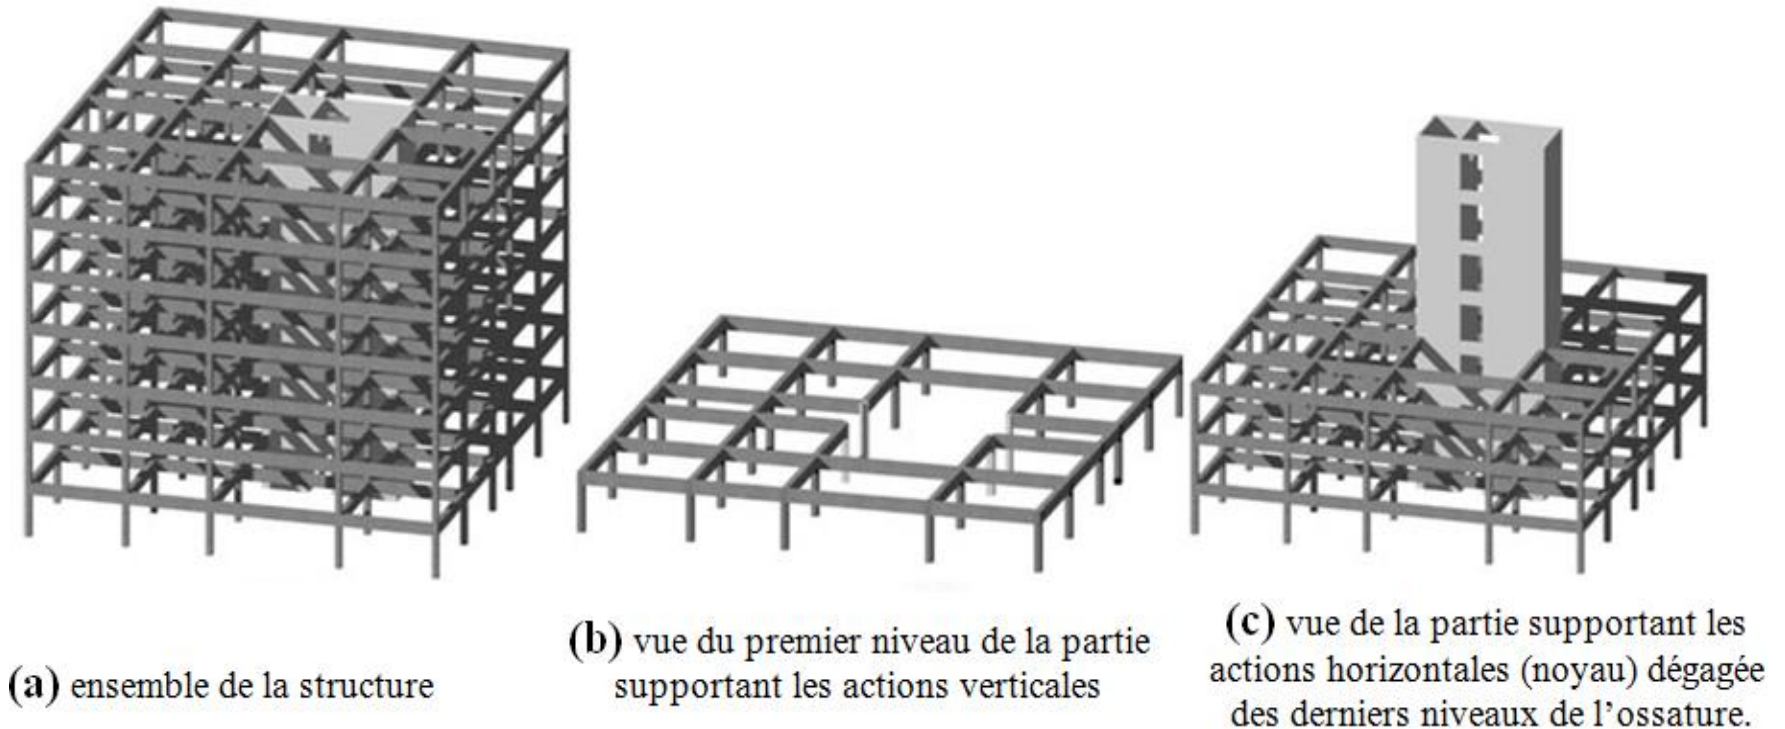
Schémas de la structure d'un bâtiment contreventé par un noyau
